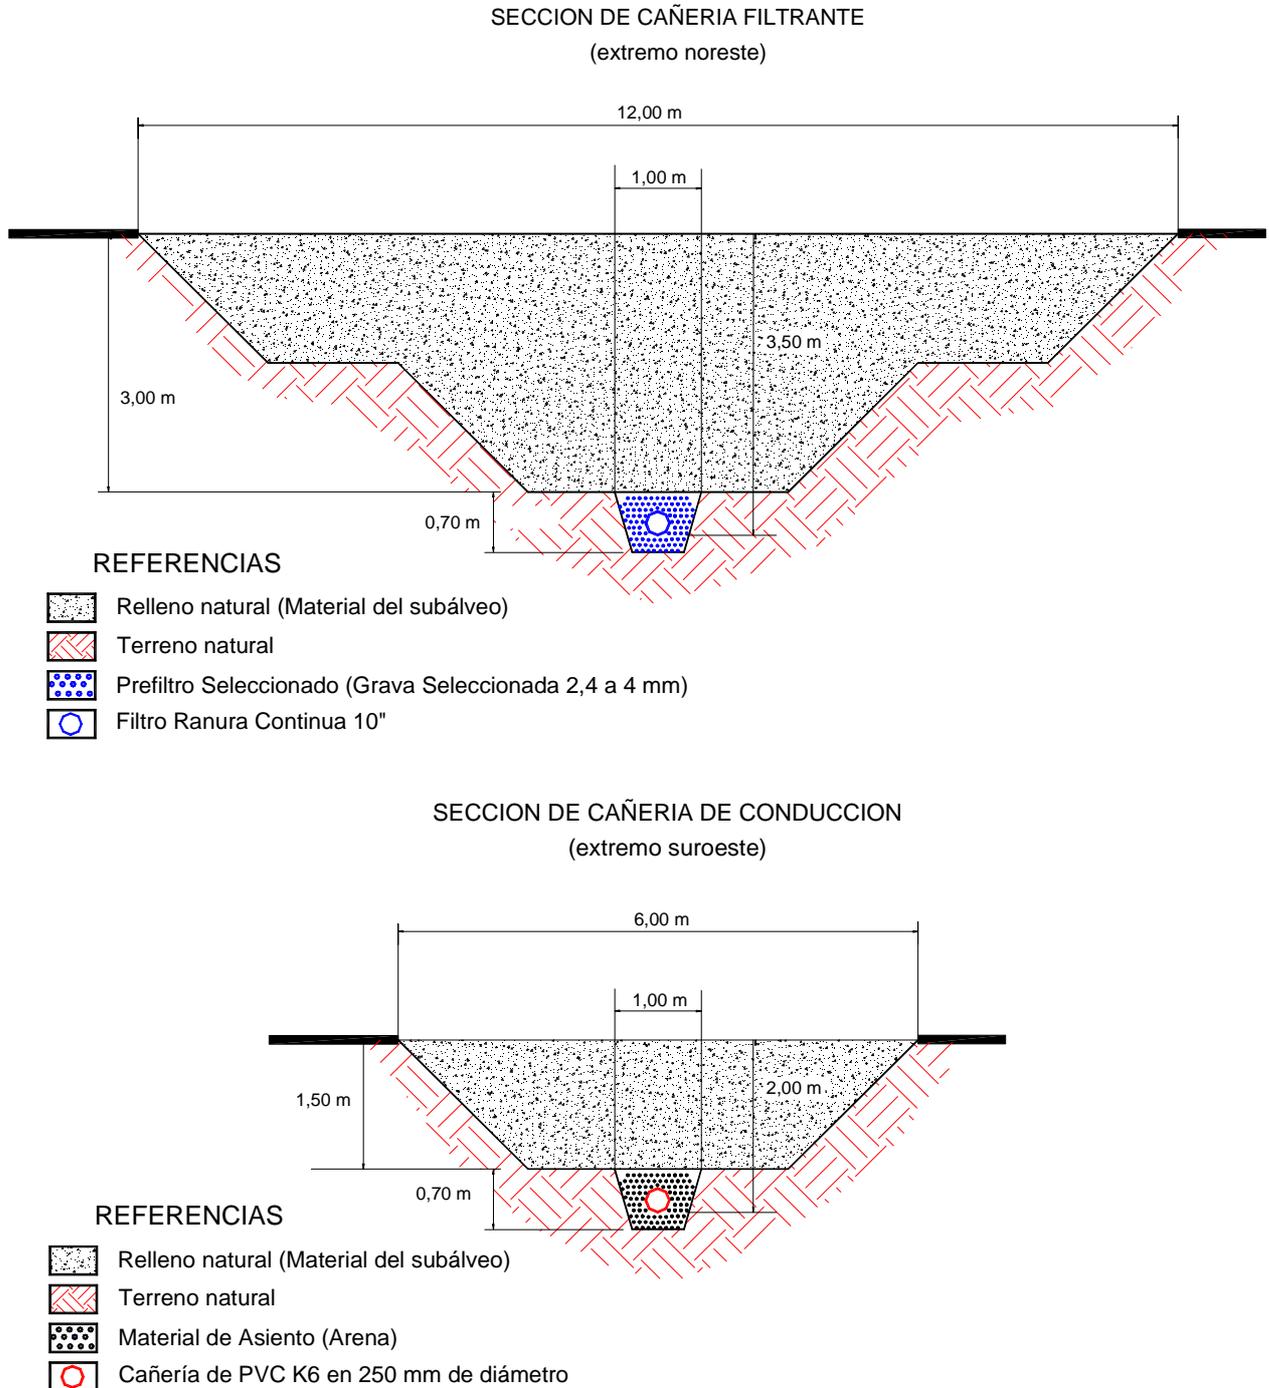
Perfiles transversales de la excavación y relleno de la obra
